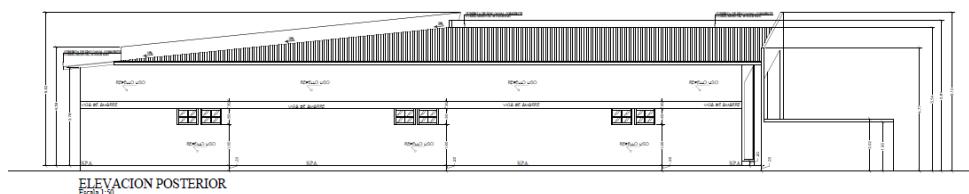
Vista elevación posterior de la plaza a Construir. Fuente: Planos del Proyecto.
